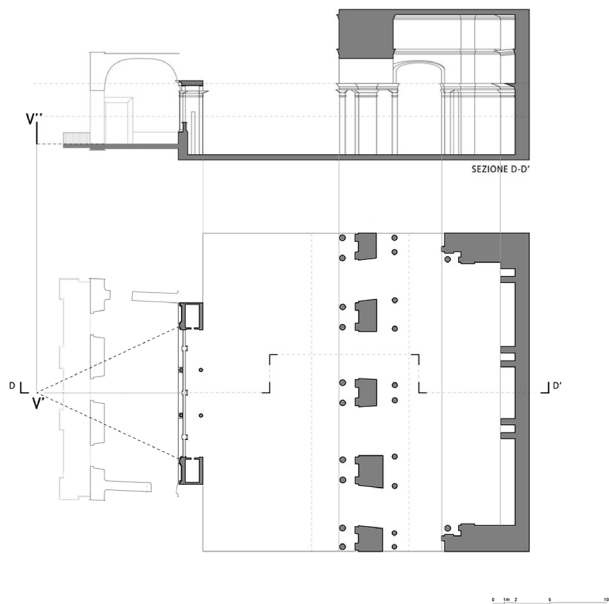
Restituzione prospettica di ulteriori elementi architettonici dipinti attraverso gli allineamenti prospettici tra centro di proiezione, immagine prospettica e posizione spaziale coerente con gli elementi architettonici precedentemente restituiti (elaborazione grafica delle autrici).
